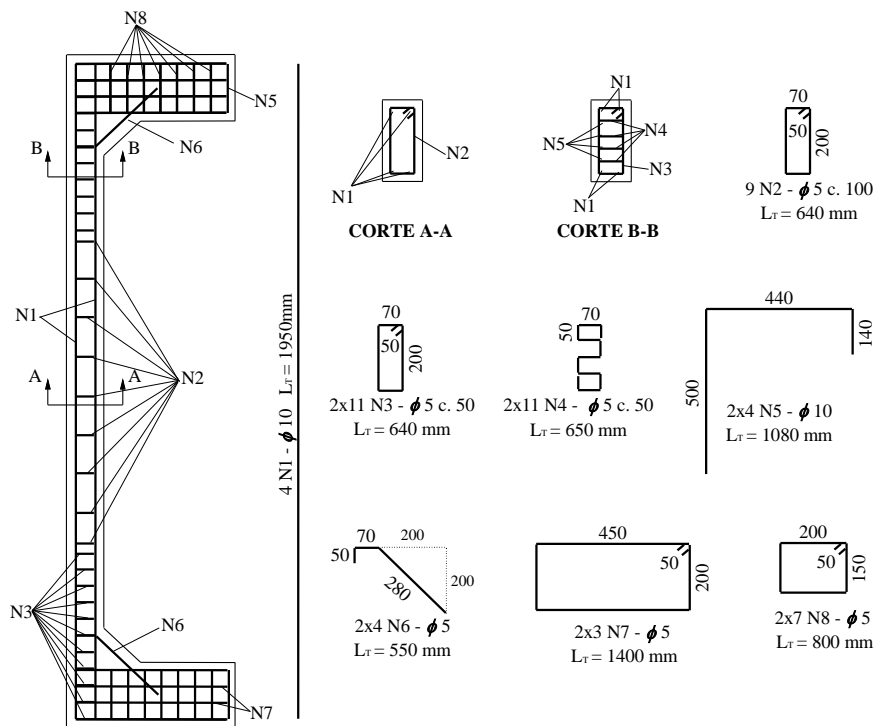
Detalhamento das armaduras dos pilares (ADORNO 2004)
